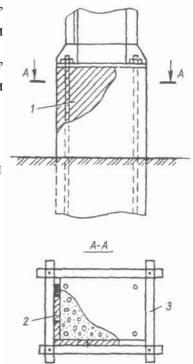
Ремонт путем бетонирования надземной части фундамента при площади повреждения менее ¹/3 его поперечного сечения: 1 — поврежденная часть фундамента; 2 — опалубка; 3 — деревянный хомут
